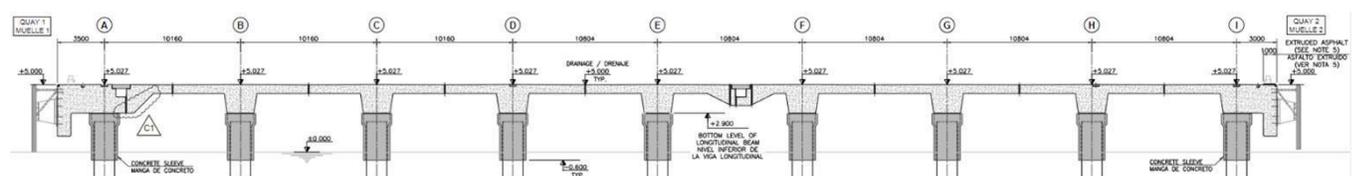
sección transversal de Q1/Q2. Fuente: Cotema.
